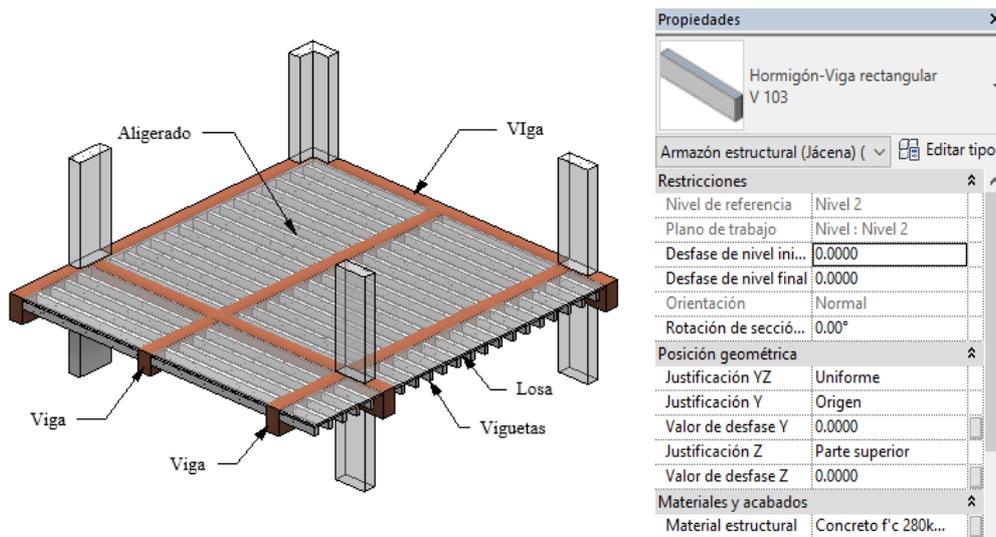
Modelamiento de vigas peraltadas y losa aligerada
